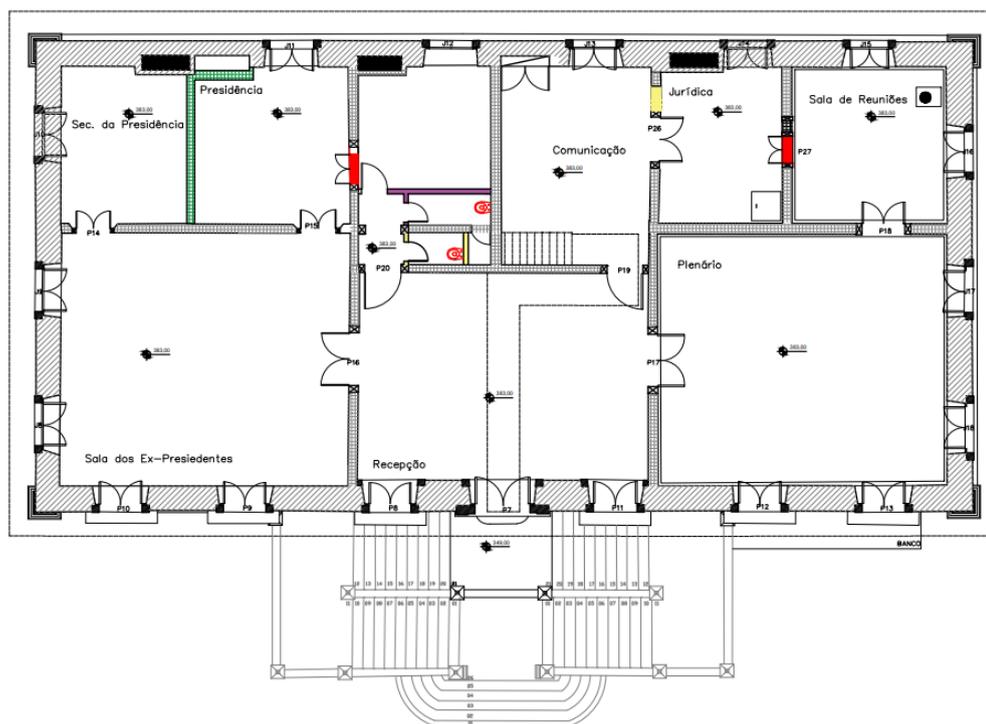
Planta 5 do segundo pavimento da edificação por volta de 1980.
